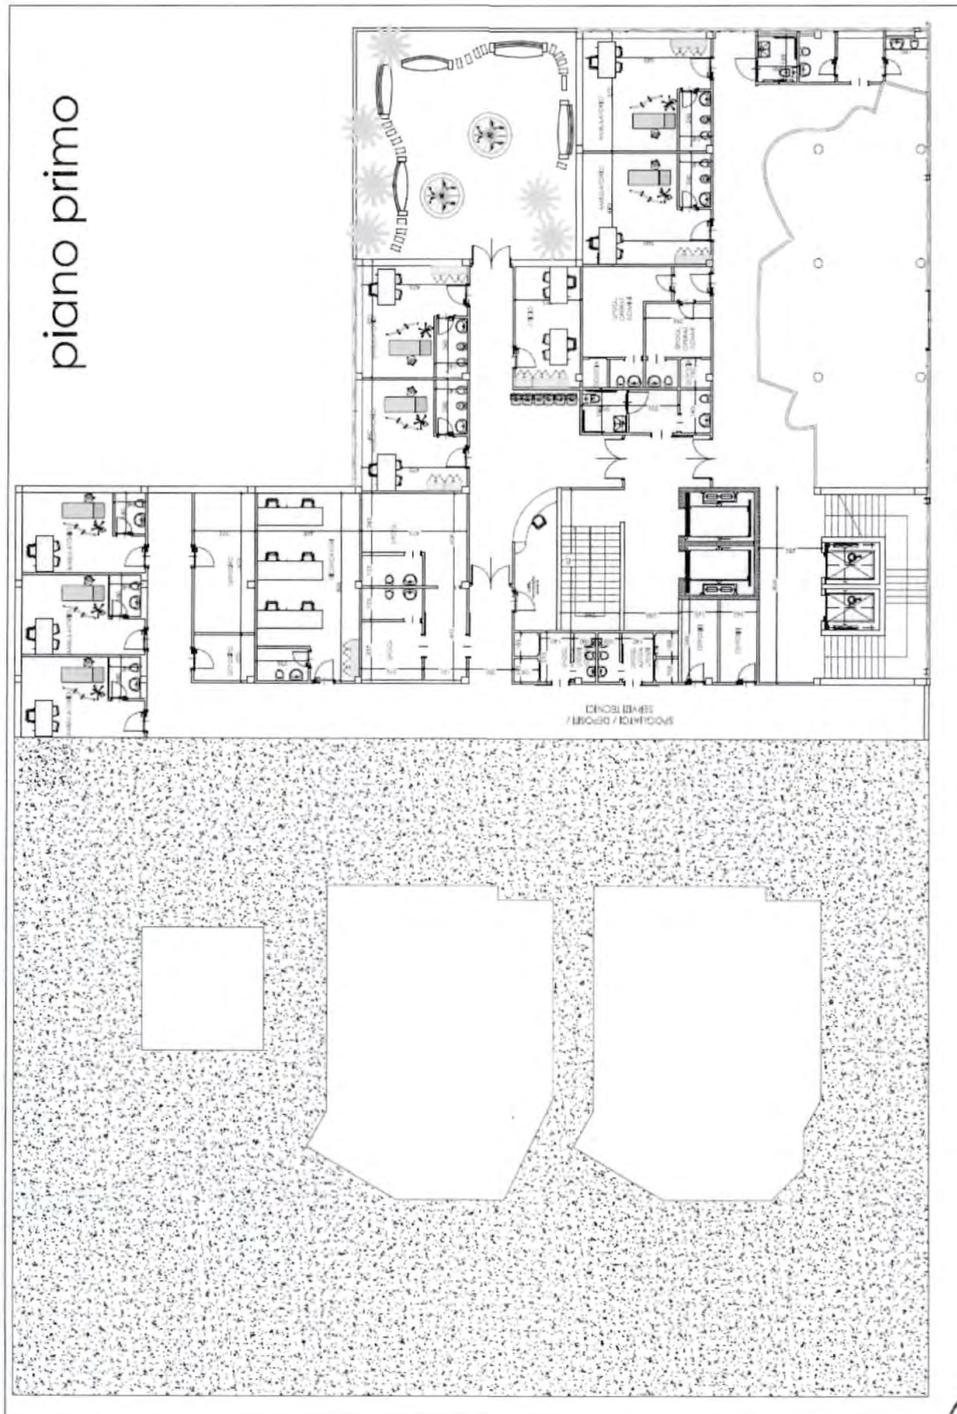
ipotesi di distribuzione planimetrica del piano primo
